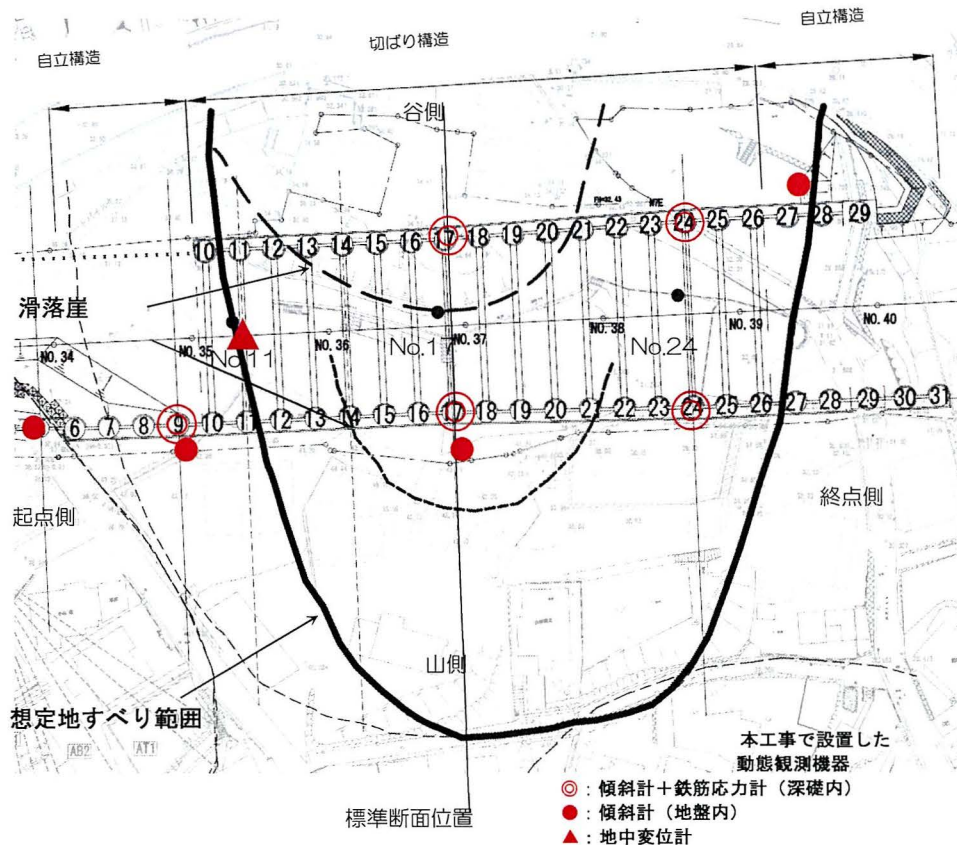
工事箇所平面図，地すべり位置と動態観測配置図
